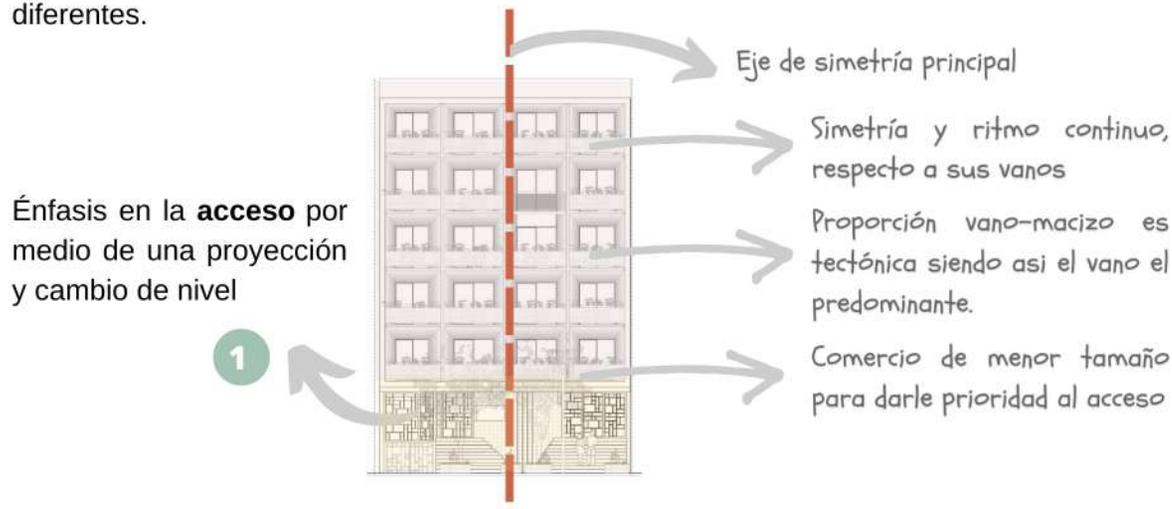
Planos de arquitectónicos. Contexto Arquitectos, 2019
